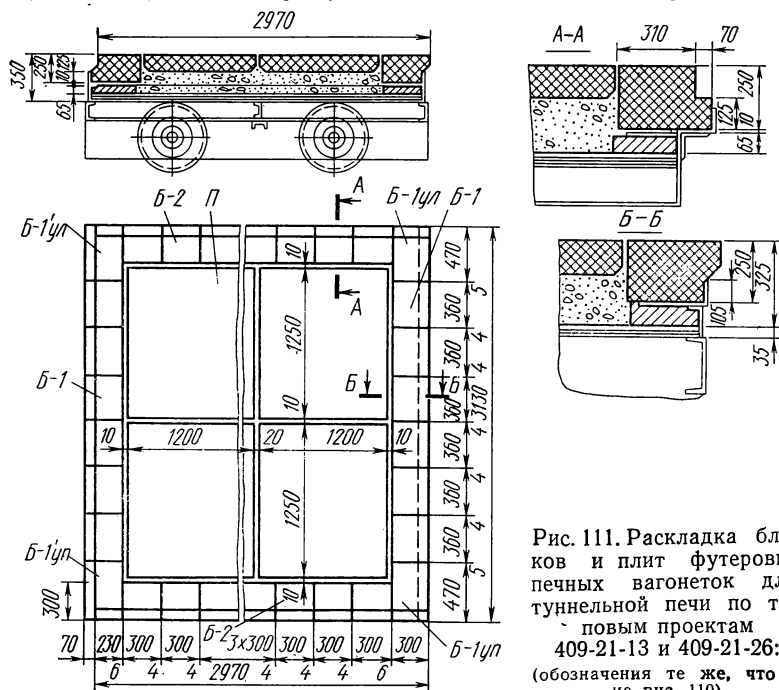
Раскладка блоков и плит футеровки печных вагонеток для туннельной печи по типовым проектам
